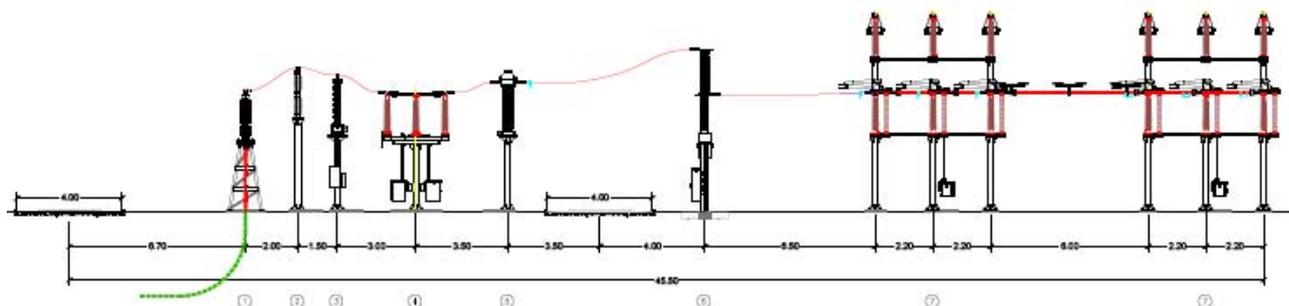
sezione futuro stallo di arrivo in Stazione Elettrica RTN
